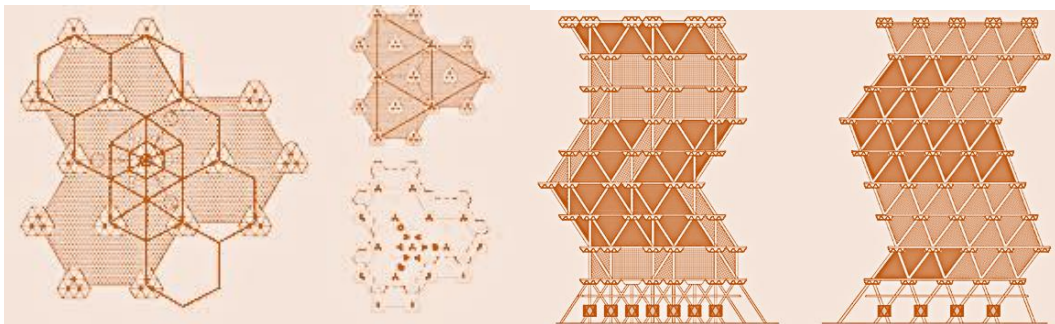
Generación de plantas y fachadas del Philadelphia City Tower.
